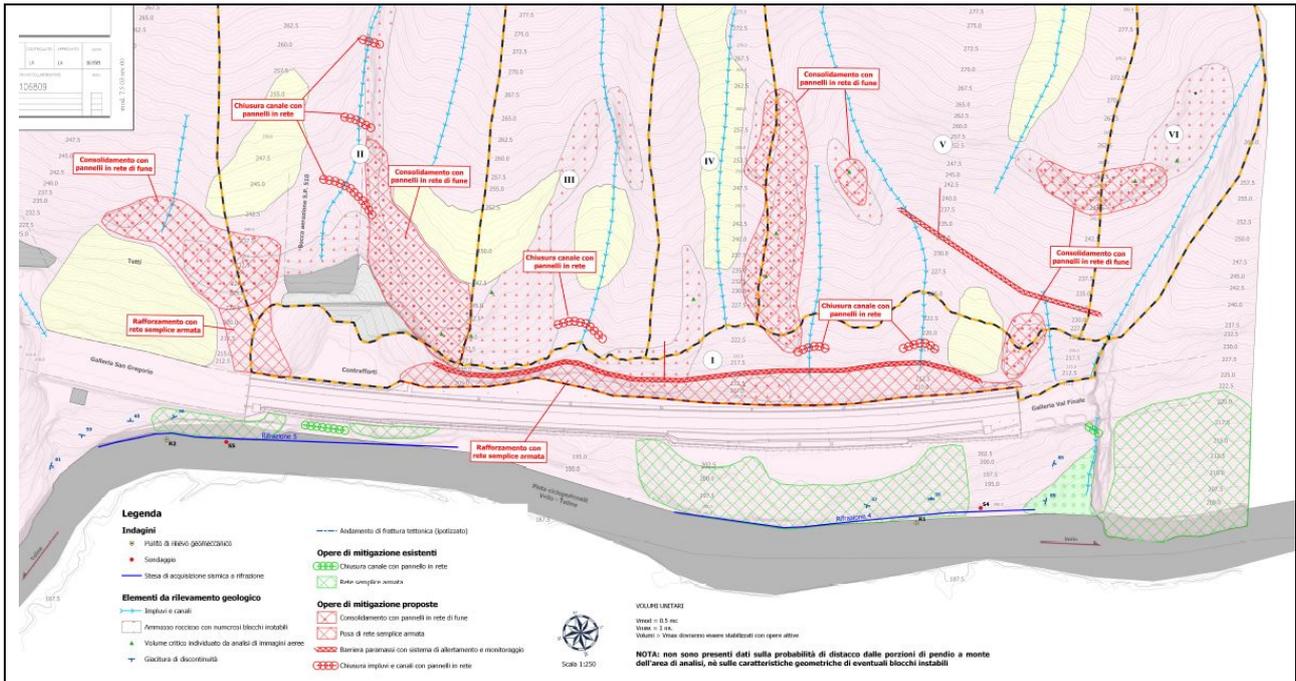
9 Planimetria d'intervento area A05 a titolo esemplificativo
